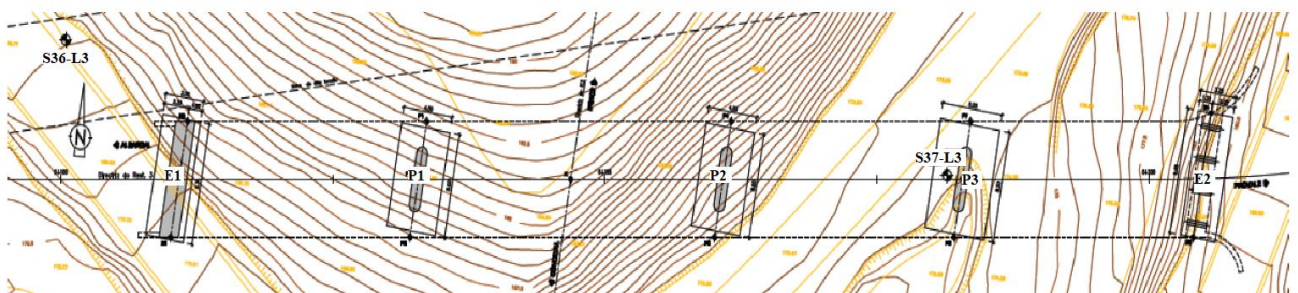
Planta de implantação da obra de arte com indicação da localização das sondagens.
